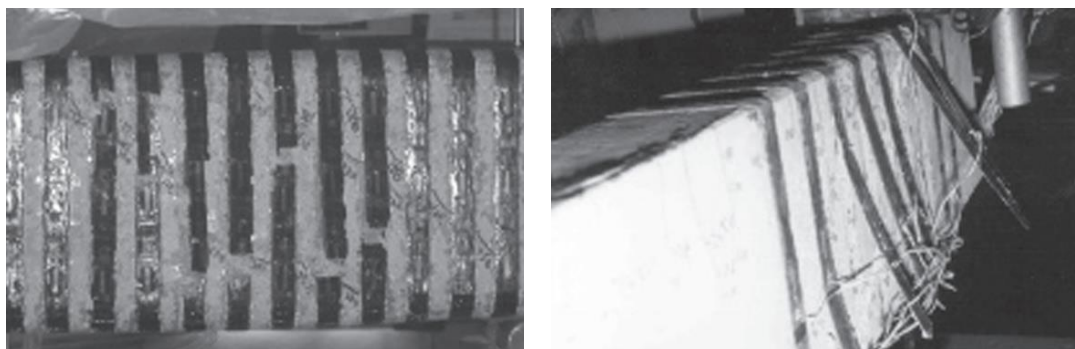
Colapso de vigas por ruptura e por descolamento do PRFC (TENG, 2008).
